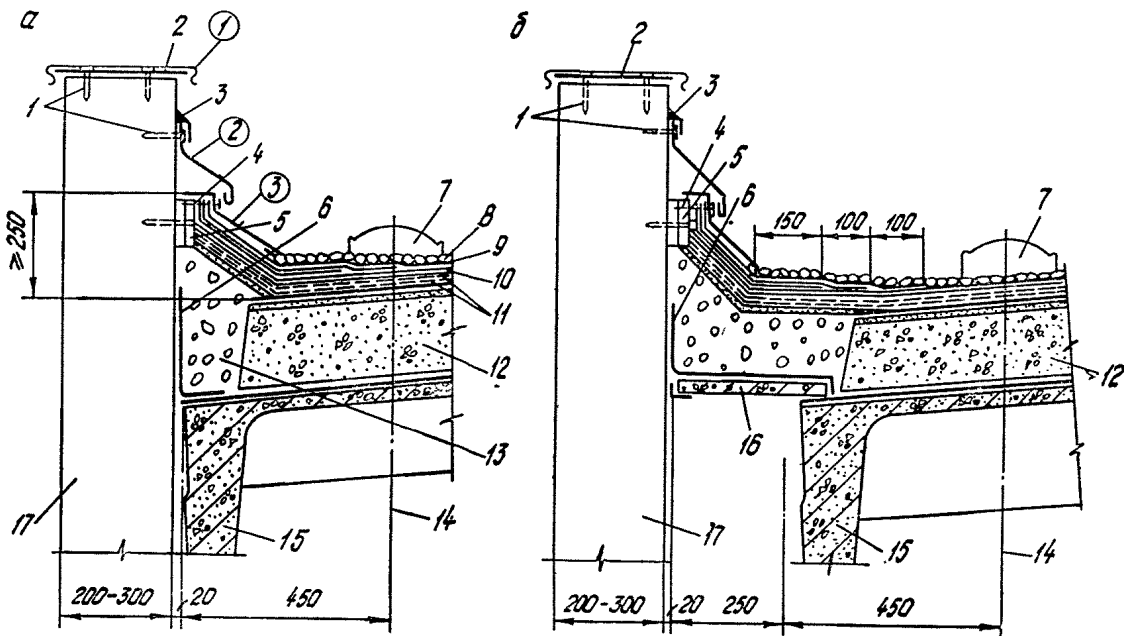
Устройство гидроизоляционного ковра в местах примыкания к парапету продольной стены
